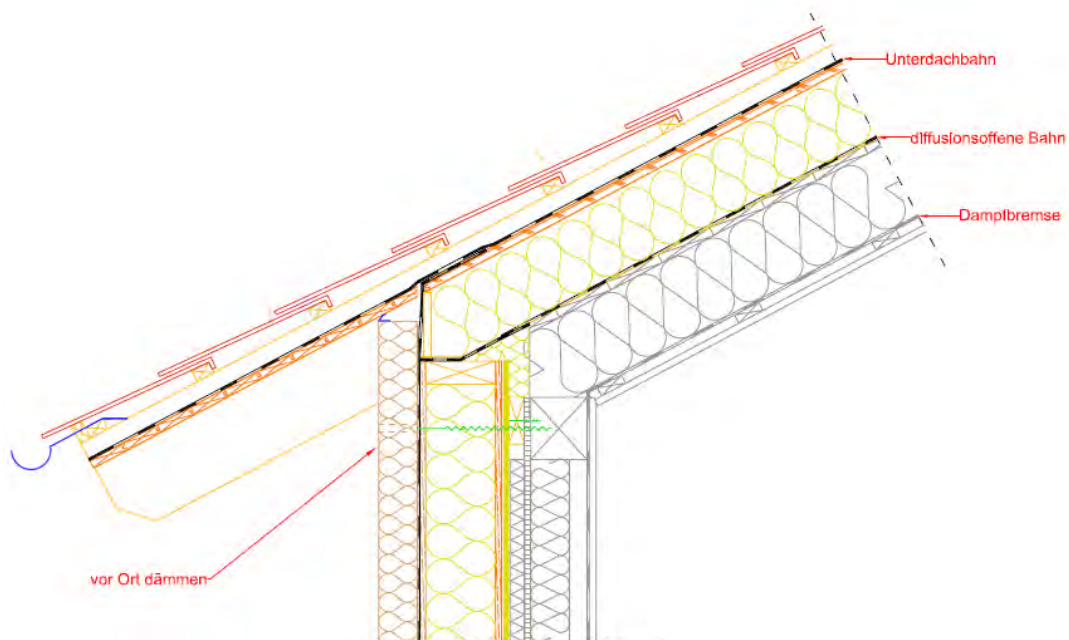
Traufendetail mit ausgebautem Dachgeschoß
